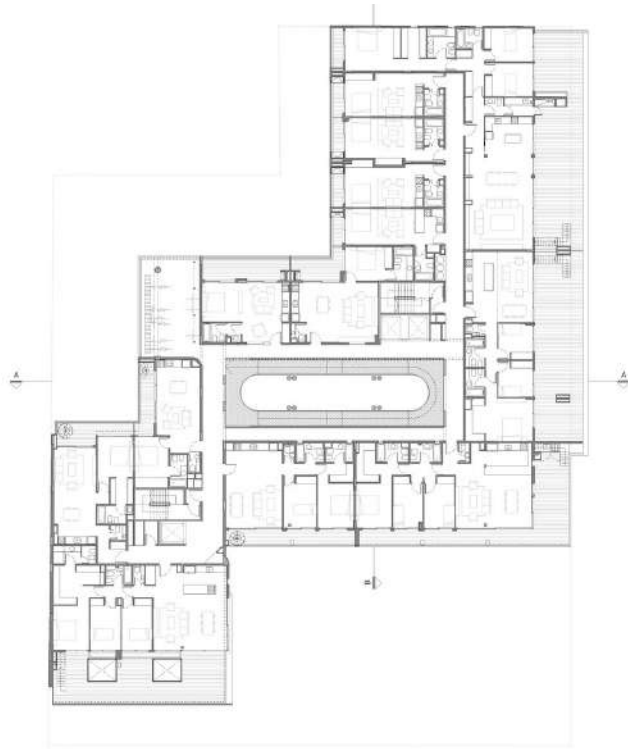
Planta nivel 5 proyecto Edificio casa HO. Fuente Plataforma arquitectura
